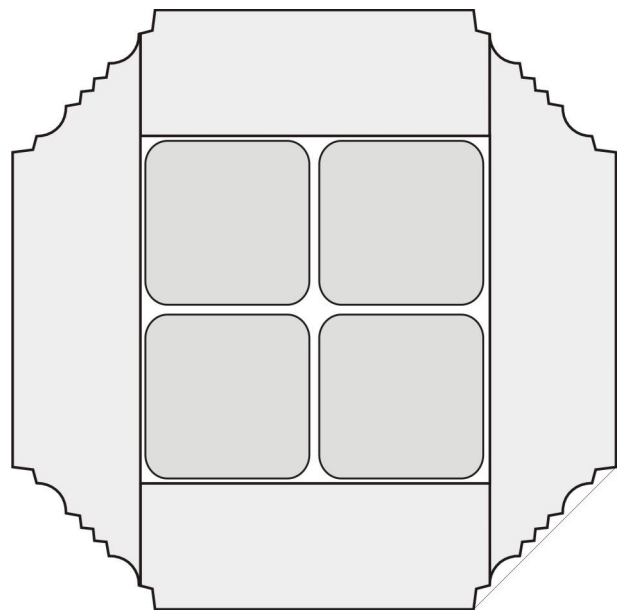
La Mercéd, Claustro Mayor. Grundriss eines Erdgeschosspfeilers, schematische Darstellung des Holzbündelpfeilers. Eigene Zeichnung, 2007.
